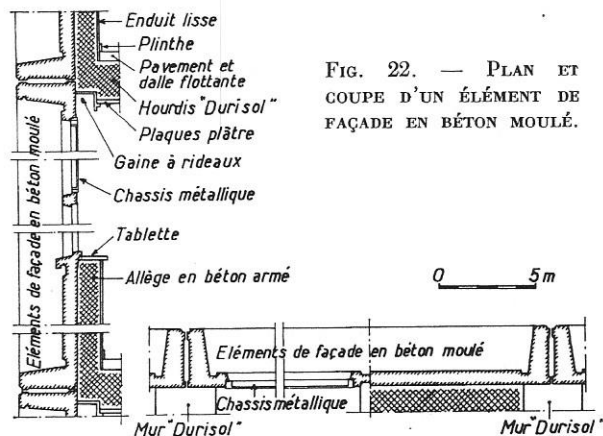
PLAN ET COUPE D'UN ÉLÉMENT DE FAÇADE EN BÉTON MOULÉ.
